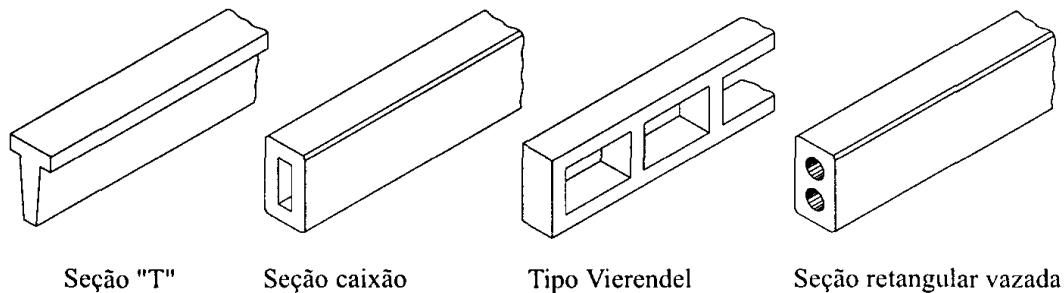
Seções transversais utilizadas nos pilares [EL DEBS, 2000]
